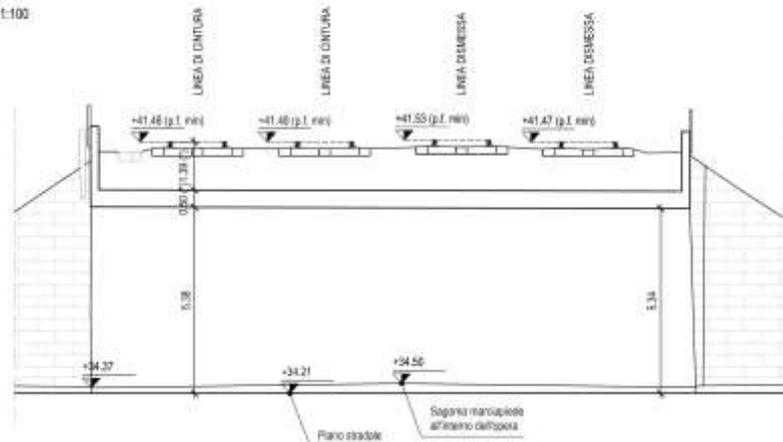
Sottovia ferroviario via Colombo, stato di fatto: sezione longitudinale
